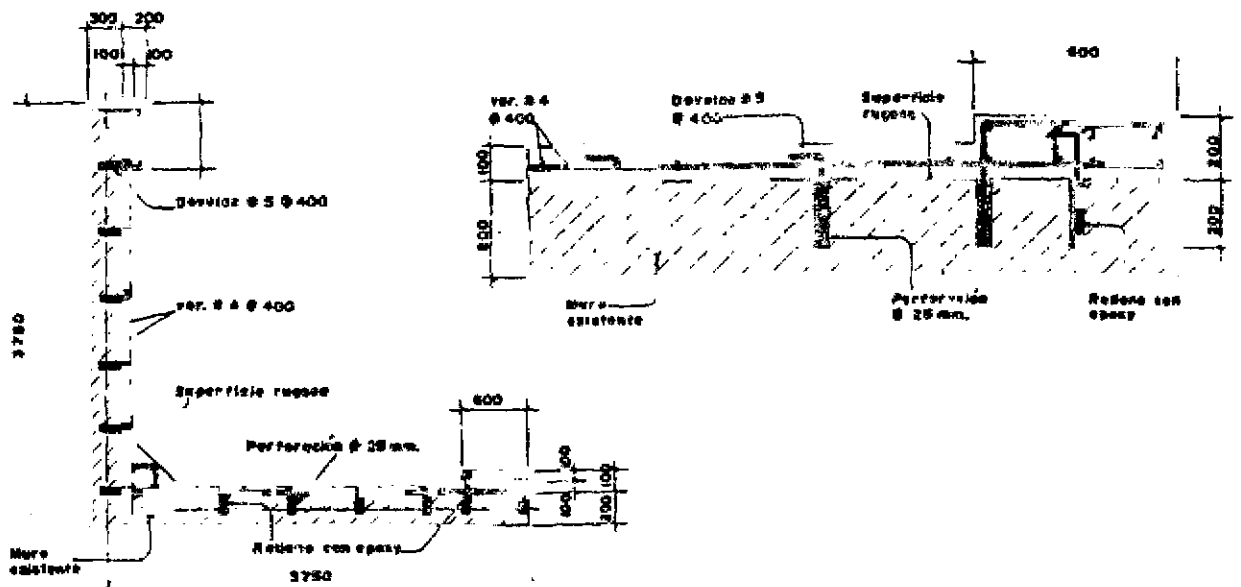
Detalle típico de conectores de acero a muros de concreto existentes.
